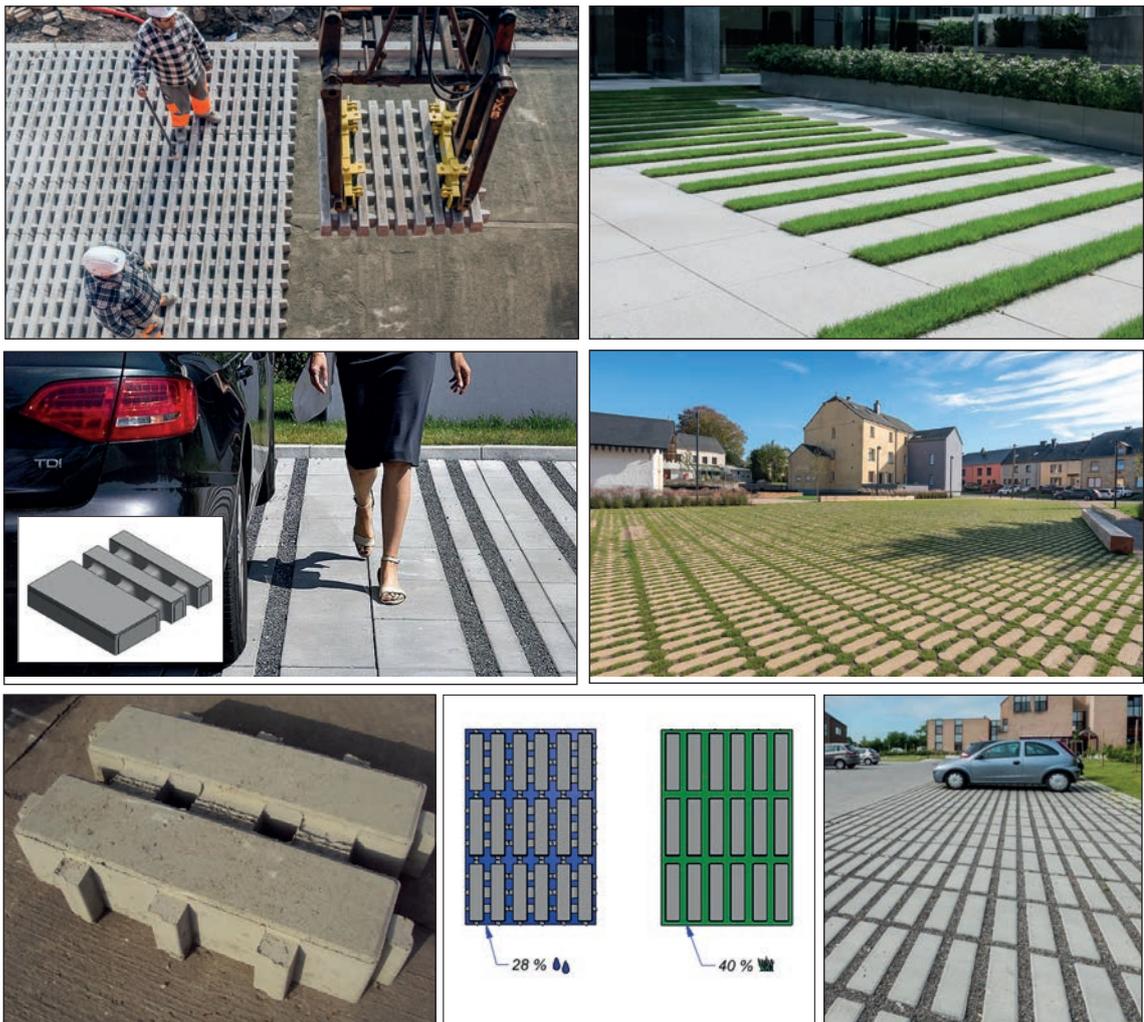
Nouvelles conceptions avec dalles de grand format et produits de béton spéciaux pour les applications drainantes
